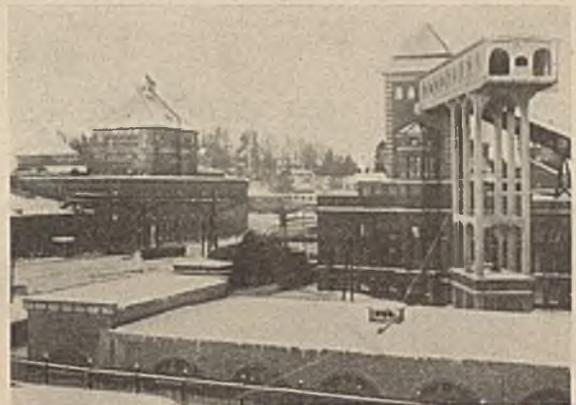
Seilbahnack und Kraftzentrale der Kaukas-Fabrik in Willmanstrand. Ausführung: Cementbyggnads A. B.
